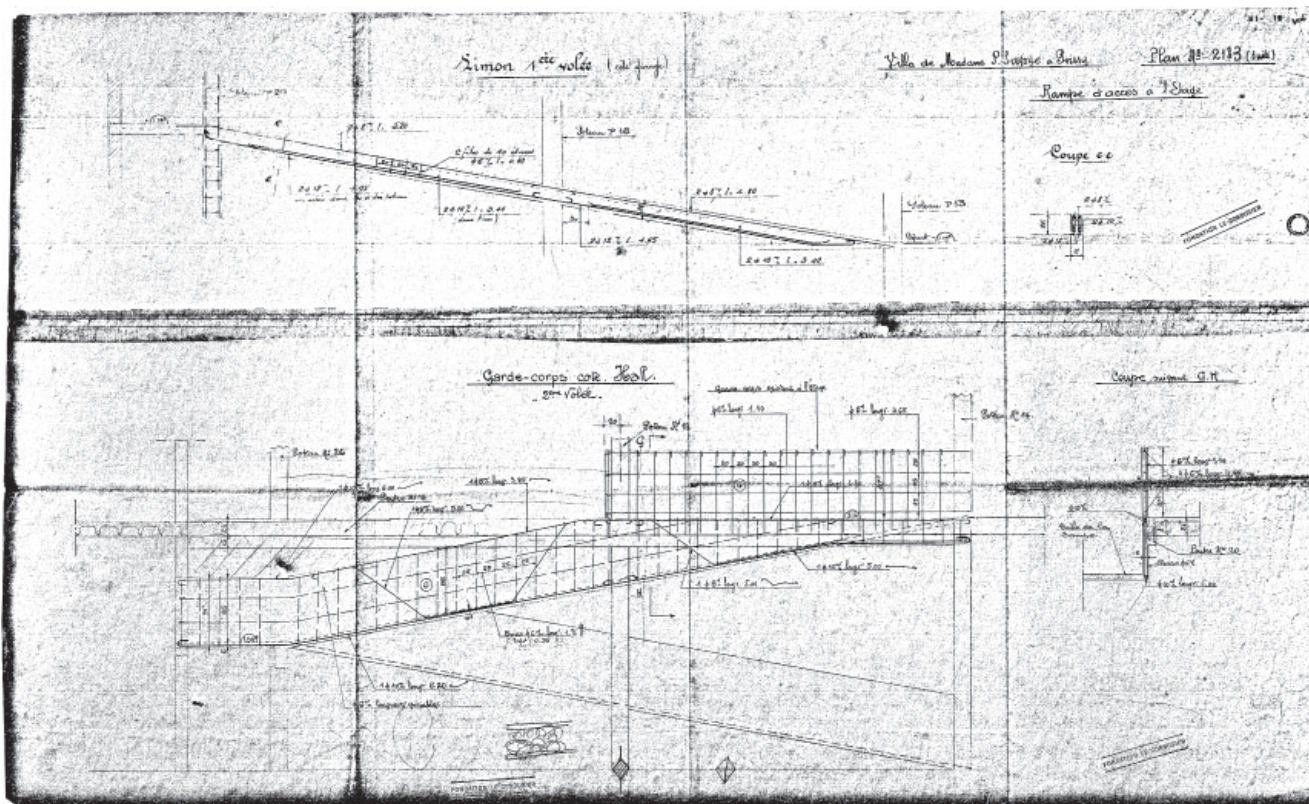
"Plan n° 2183 (suite) / Rampe d'accès à l'Étage" de la Villa Savoye, a escala 1:50, Cormier, FLC H1 (13) 306.
